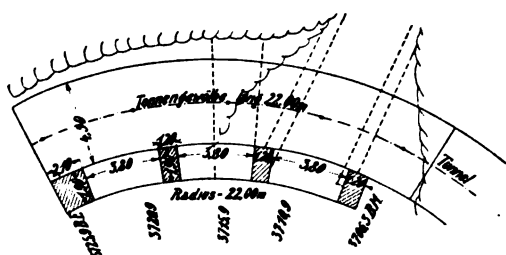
Grundriß der Lawinenschutzgalerie beim Frattner Tobel.
